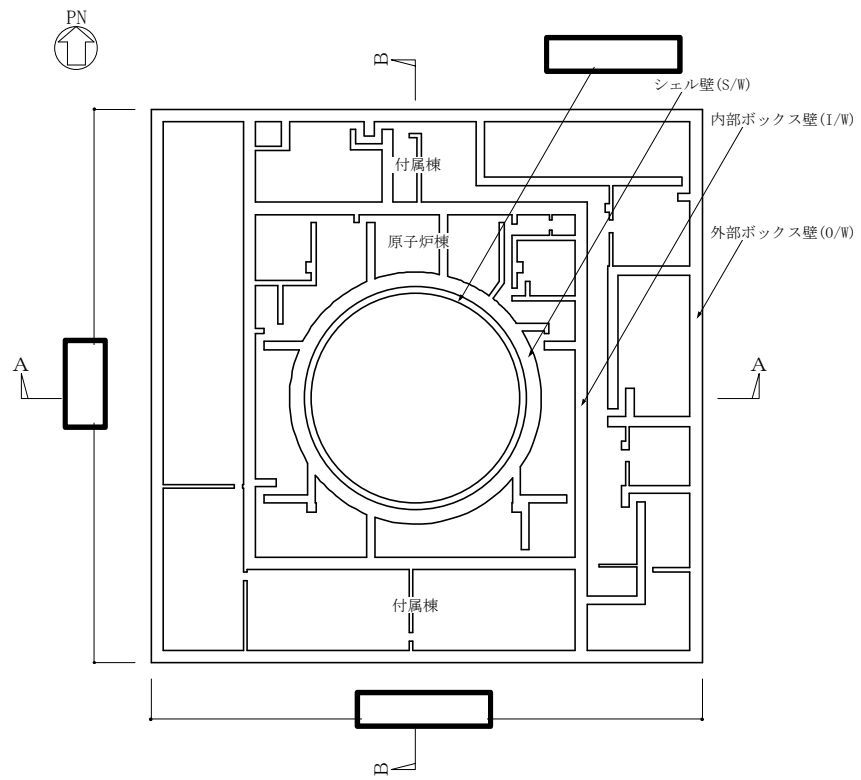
(1/10) 原子炉建屋の概略平面図 (EL. -4.0 m)
